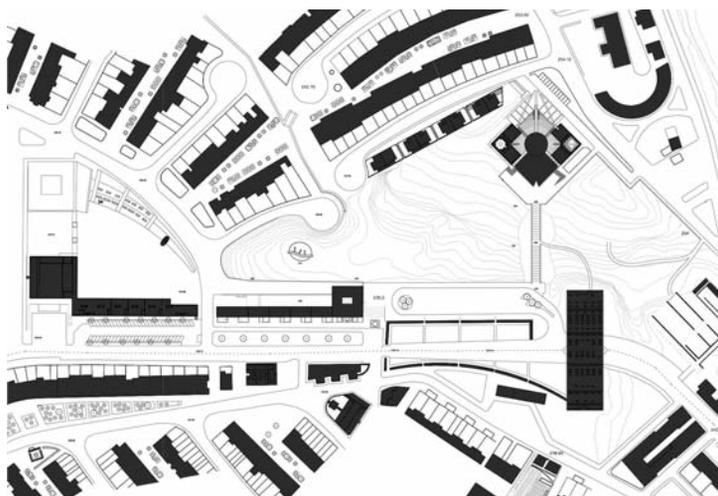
Planimetria del Centro Civico di Gibellina Nuova, stato di fatto
